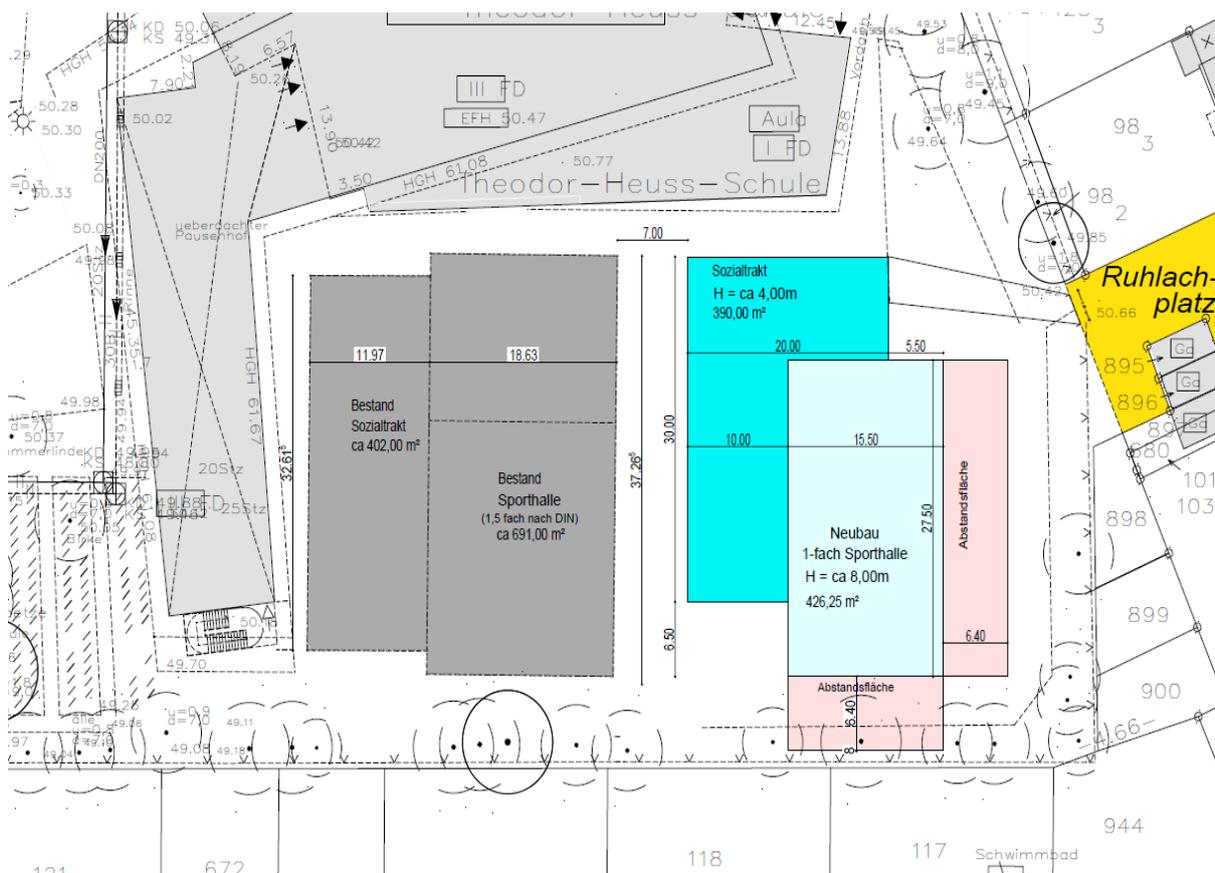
Flächenlayout Variante A (Bestandshalle und Neubau einer Einfeld-Sporthalle)
